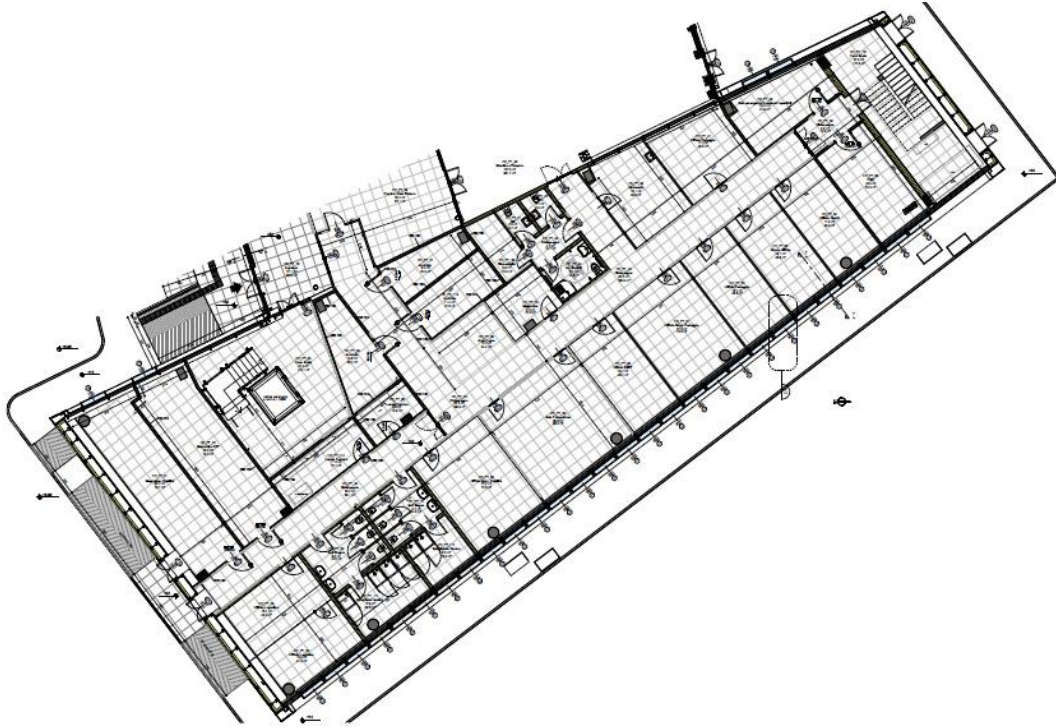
Planimetria (piano terreno) del complesso immobiliare in progetto
